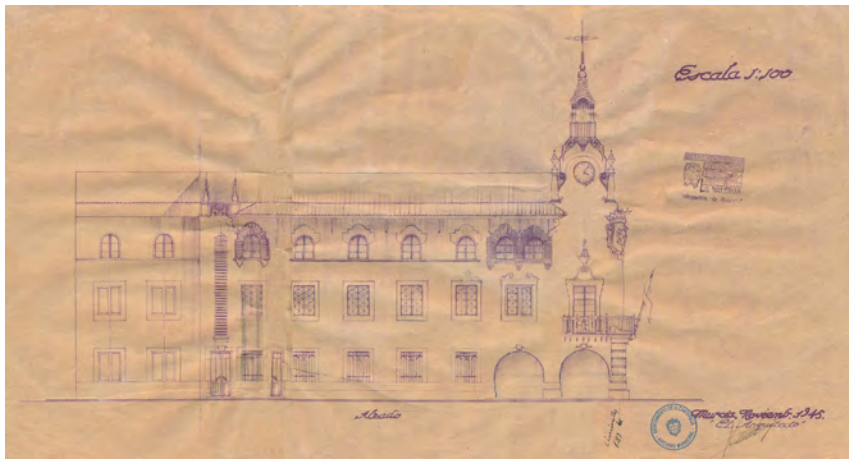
y 6. Alzado de la fachada de la plaza de San Pedro y puerta principal. 1945. Proyecto Casa Ayuntamiento de Alcantarilla. Joaquín Dicenta. Archivo Municipal de Alcantarilla.
